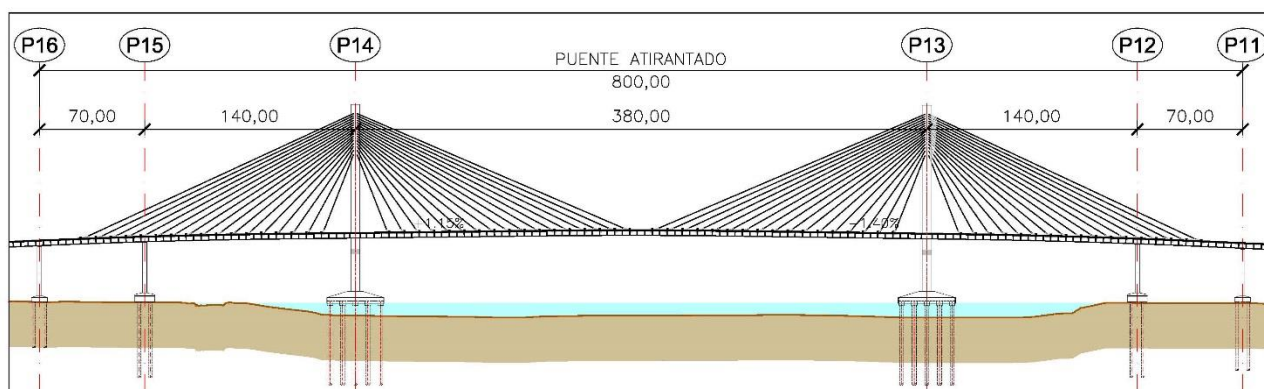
Alzado del tramo atirantado del Nuevo Puente Pumarejo
